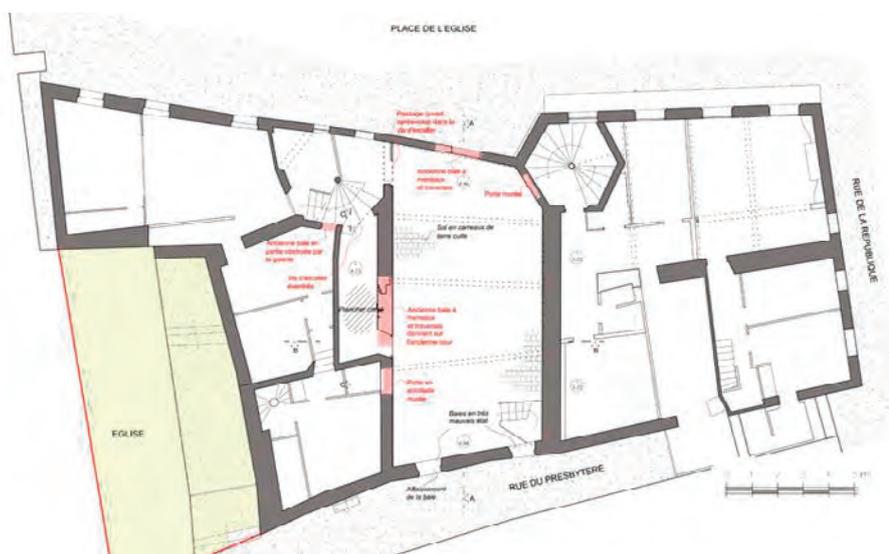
Plan du premier étage de la « maison du Viguiier » au XVI^e siècle
